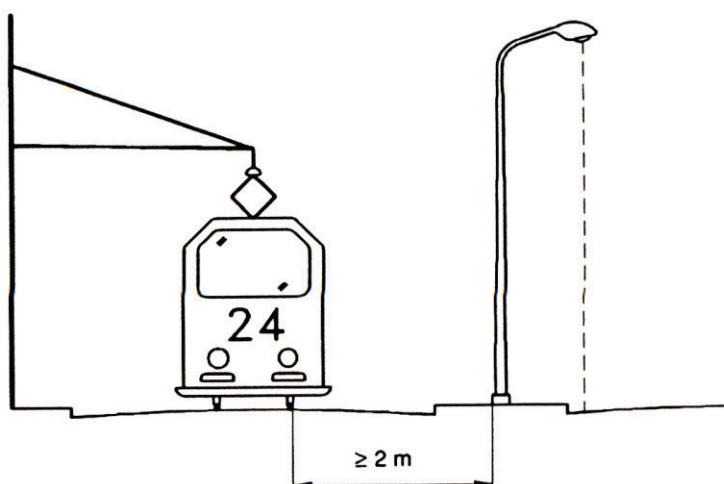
Distanza di rispetto dei centri luminosi dalle linee aeree nude a tensione superiore a 1000 V.
